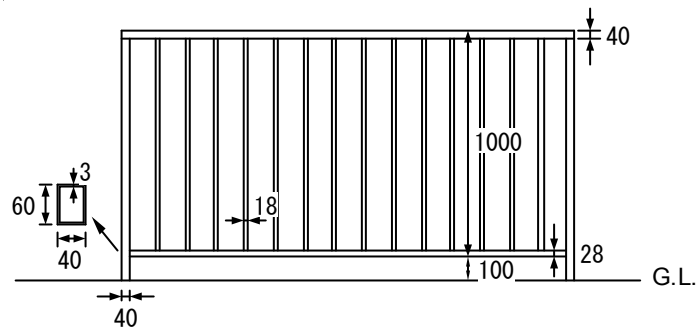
転倒したフェンス立面図 (単位: mm)
